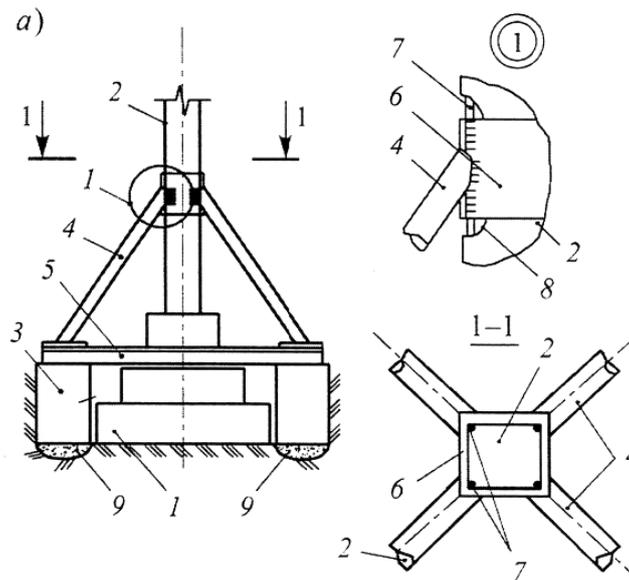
Установка раскосов для передачи части нагрузки от колонны на основание: 1 – усиливаемый фундамент; 2 – железобетонная колонна; 3 – элементы усиления фундамента; 4 – металлические раскосы; 5 – металлическая балка; 6 – металлическая обойма, привариваемая к арматуре колонны; 7 – арматура колонны; 8 – оголенный от защитного слоя участок колонны
